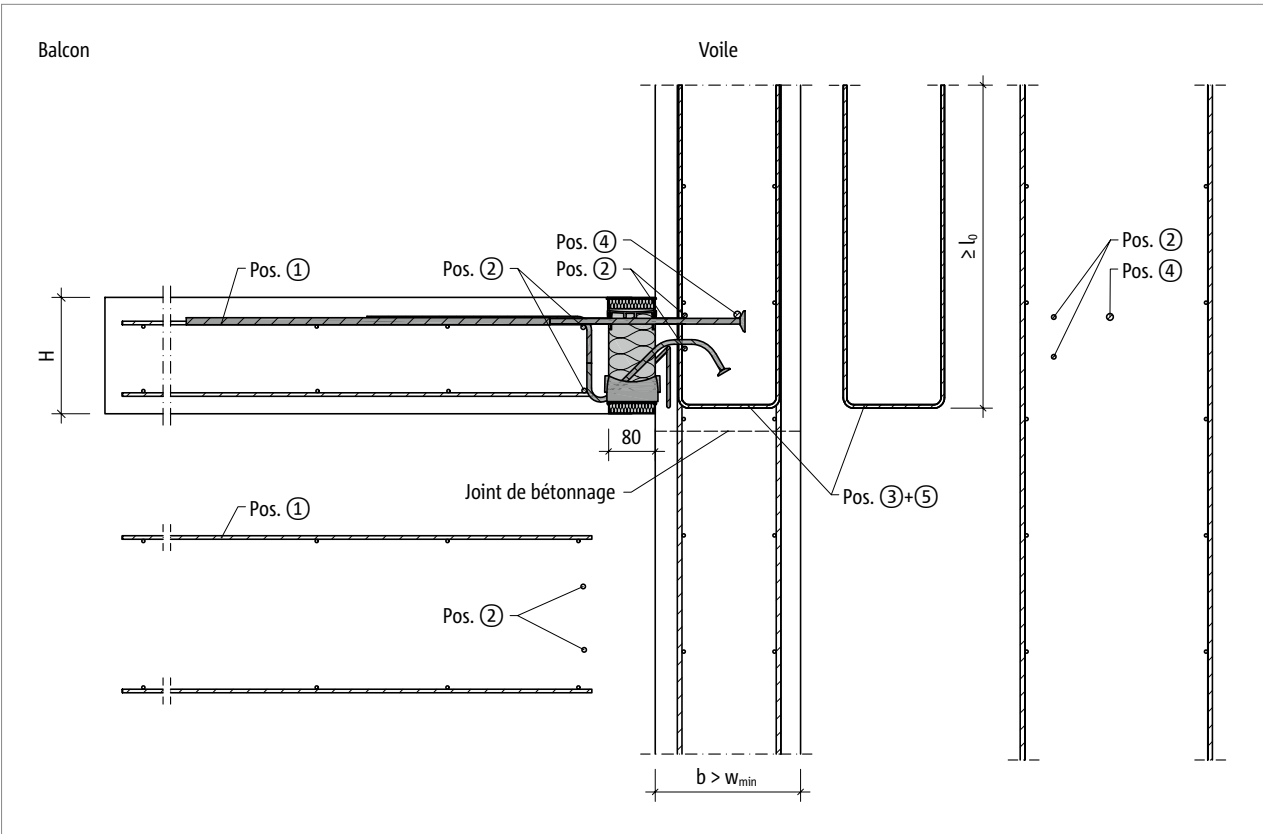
Schöck Isokorb® T type K-U : Renforcement sur site pour raccordement mural vers le haut avec une dimension plus grande du composant ($w_{pres} > w_{min}$)
